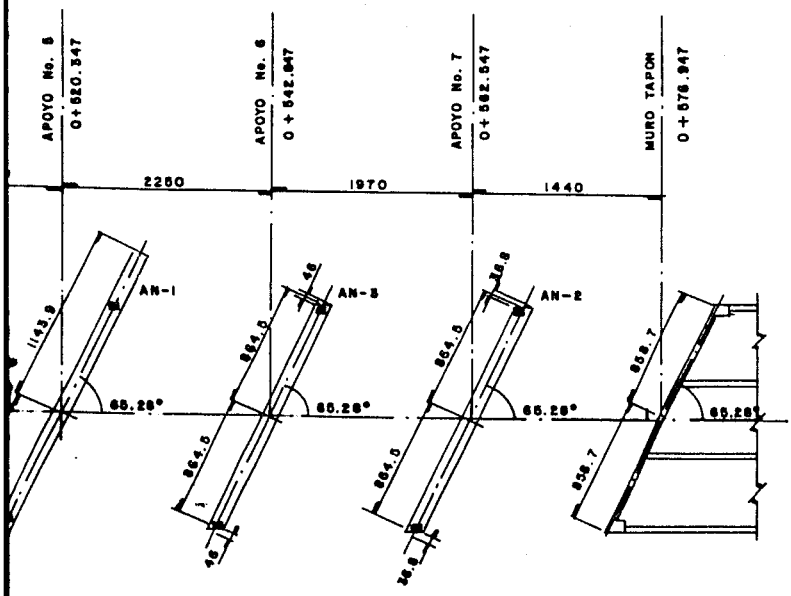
PLANTA DE APOYOS DE PUENTES.
